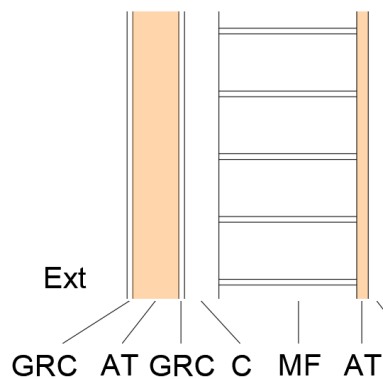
Esquema del sistema constructivo de la fachada de G.R.C. sobre pared de termoarcilla.
